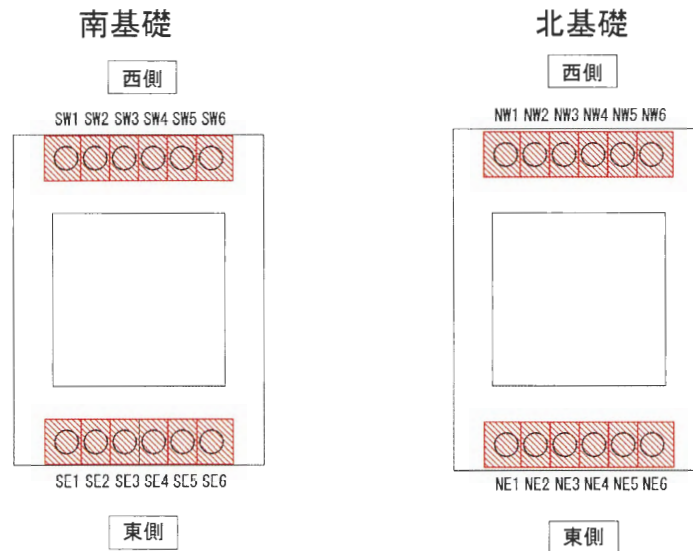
鋼管杭及び巻立て鉄筋コンクリートの平面配置
